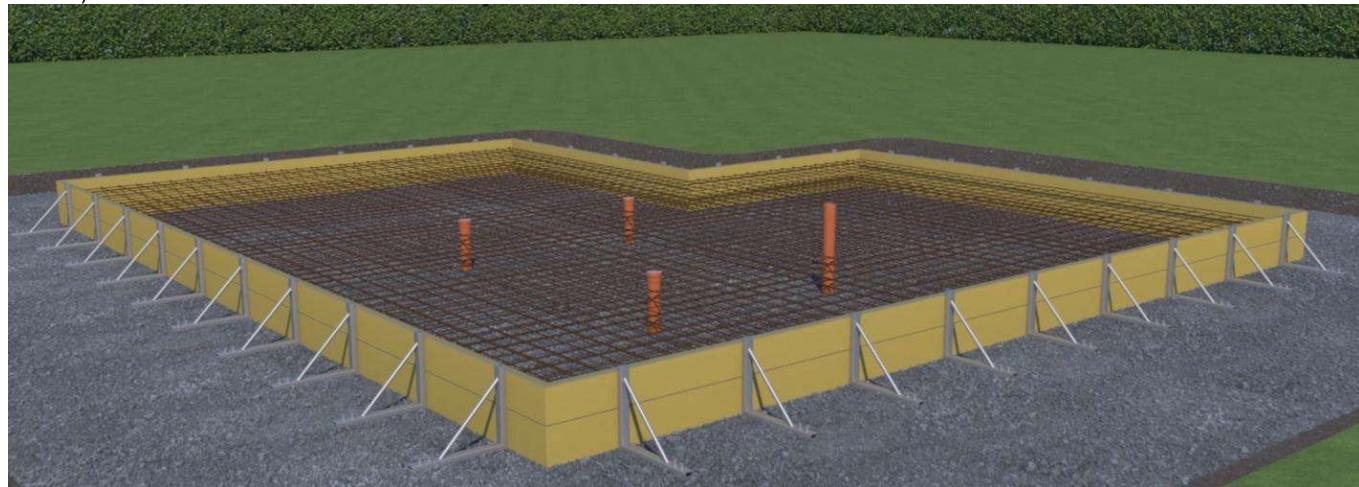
Realizzazione di una platea di fondazione con tubi installati verticalmente
